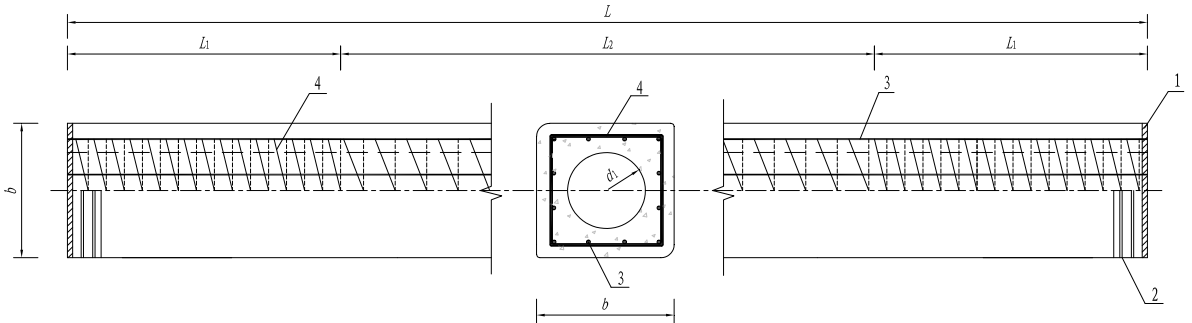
2-2 预应力混凝土空心方桩、预应力高强混凝土空心方桩、预应力超高强混凝土空心方桩、薄壁混凝土空心方桩结构形式图
